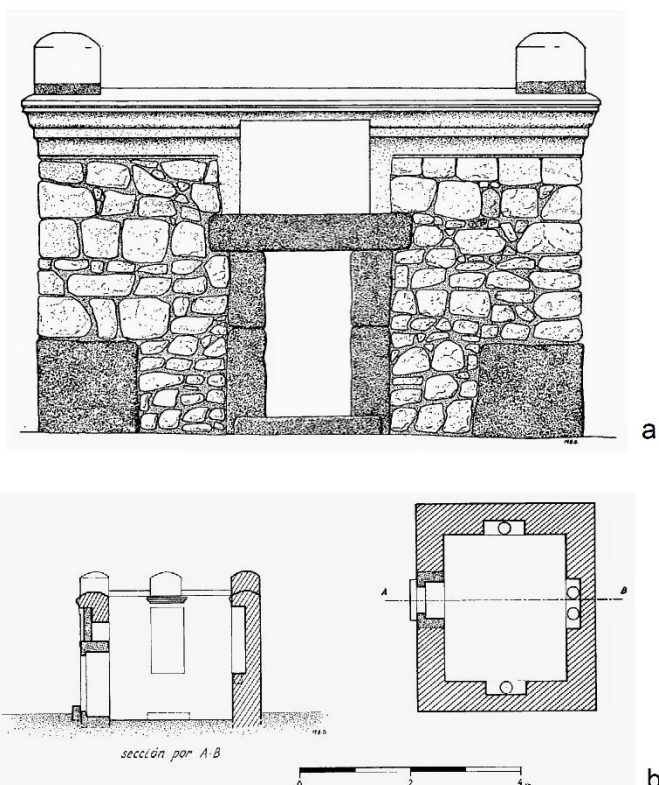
a) Prospetto della facciata. b) Sezione e pianta della tomba dei Voconii.
